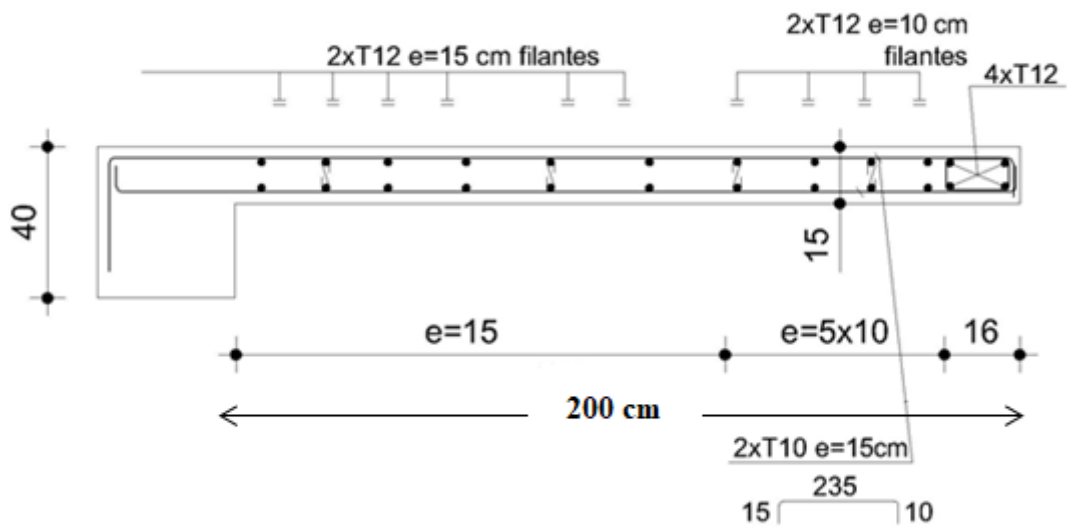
Schéma ferrailage vertical (V7, V8)
